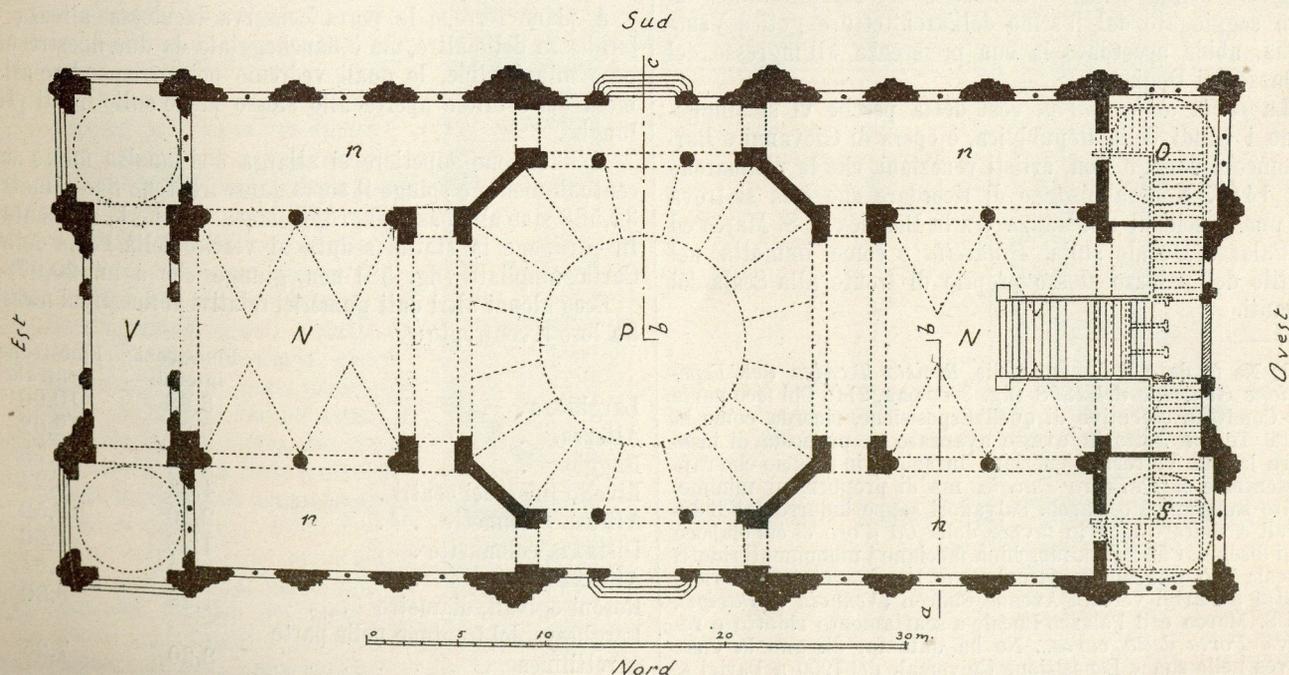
Planimetria di pianterreno del Padiglione Italiano.
